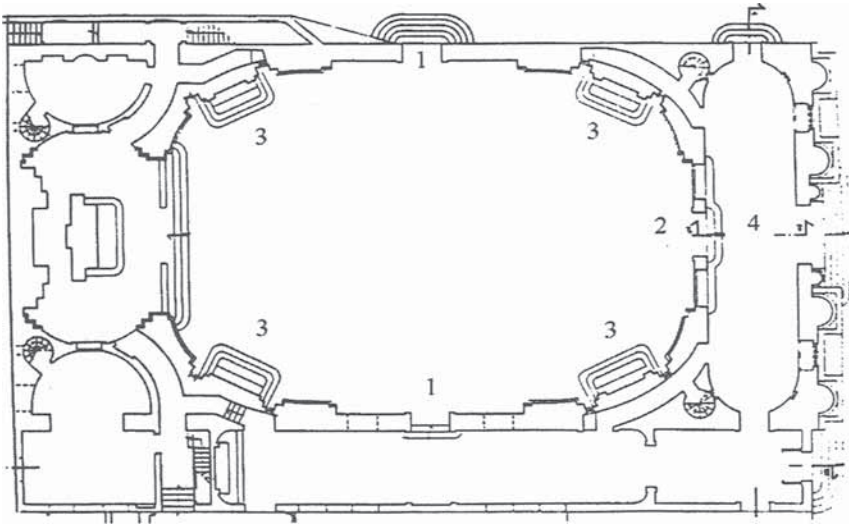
Kirche der Pietà: Grundriss
